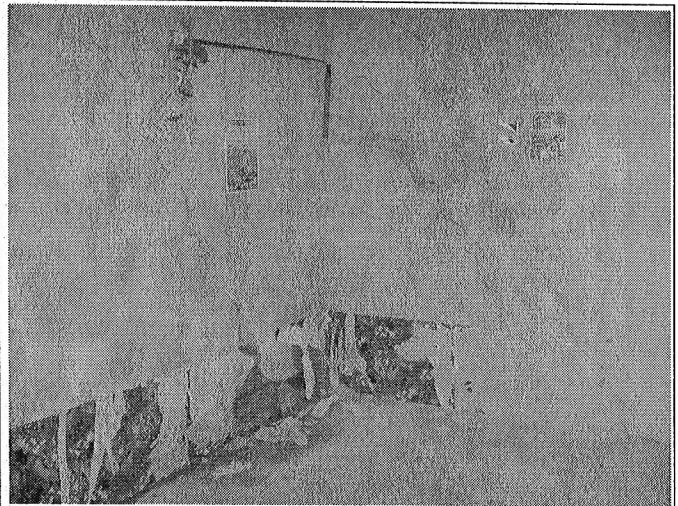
Fisura de 2 cm de ancho aproximadamente, presentada en muros divisorios del lote 2 de la manzana 14 (Observar Figura 1)
